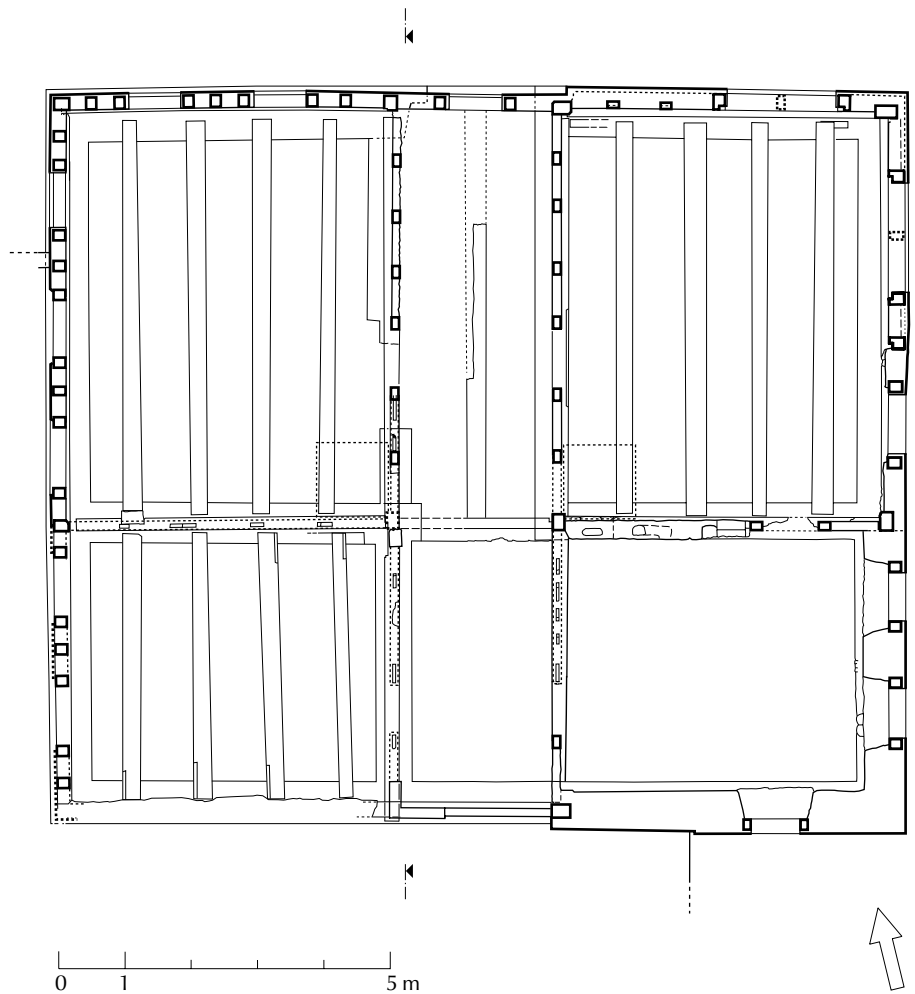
Grundriss des ersten Wohngeschosses.
